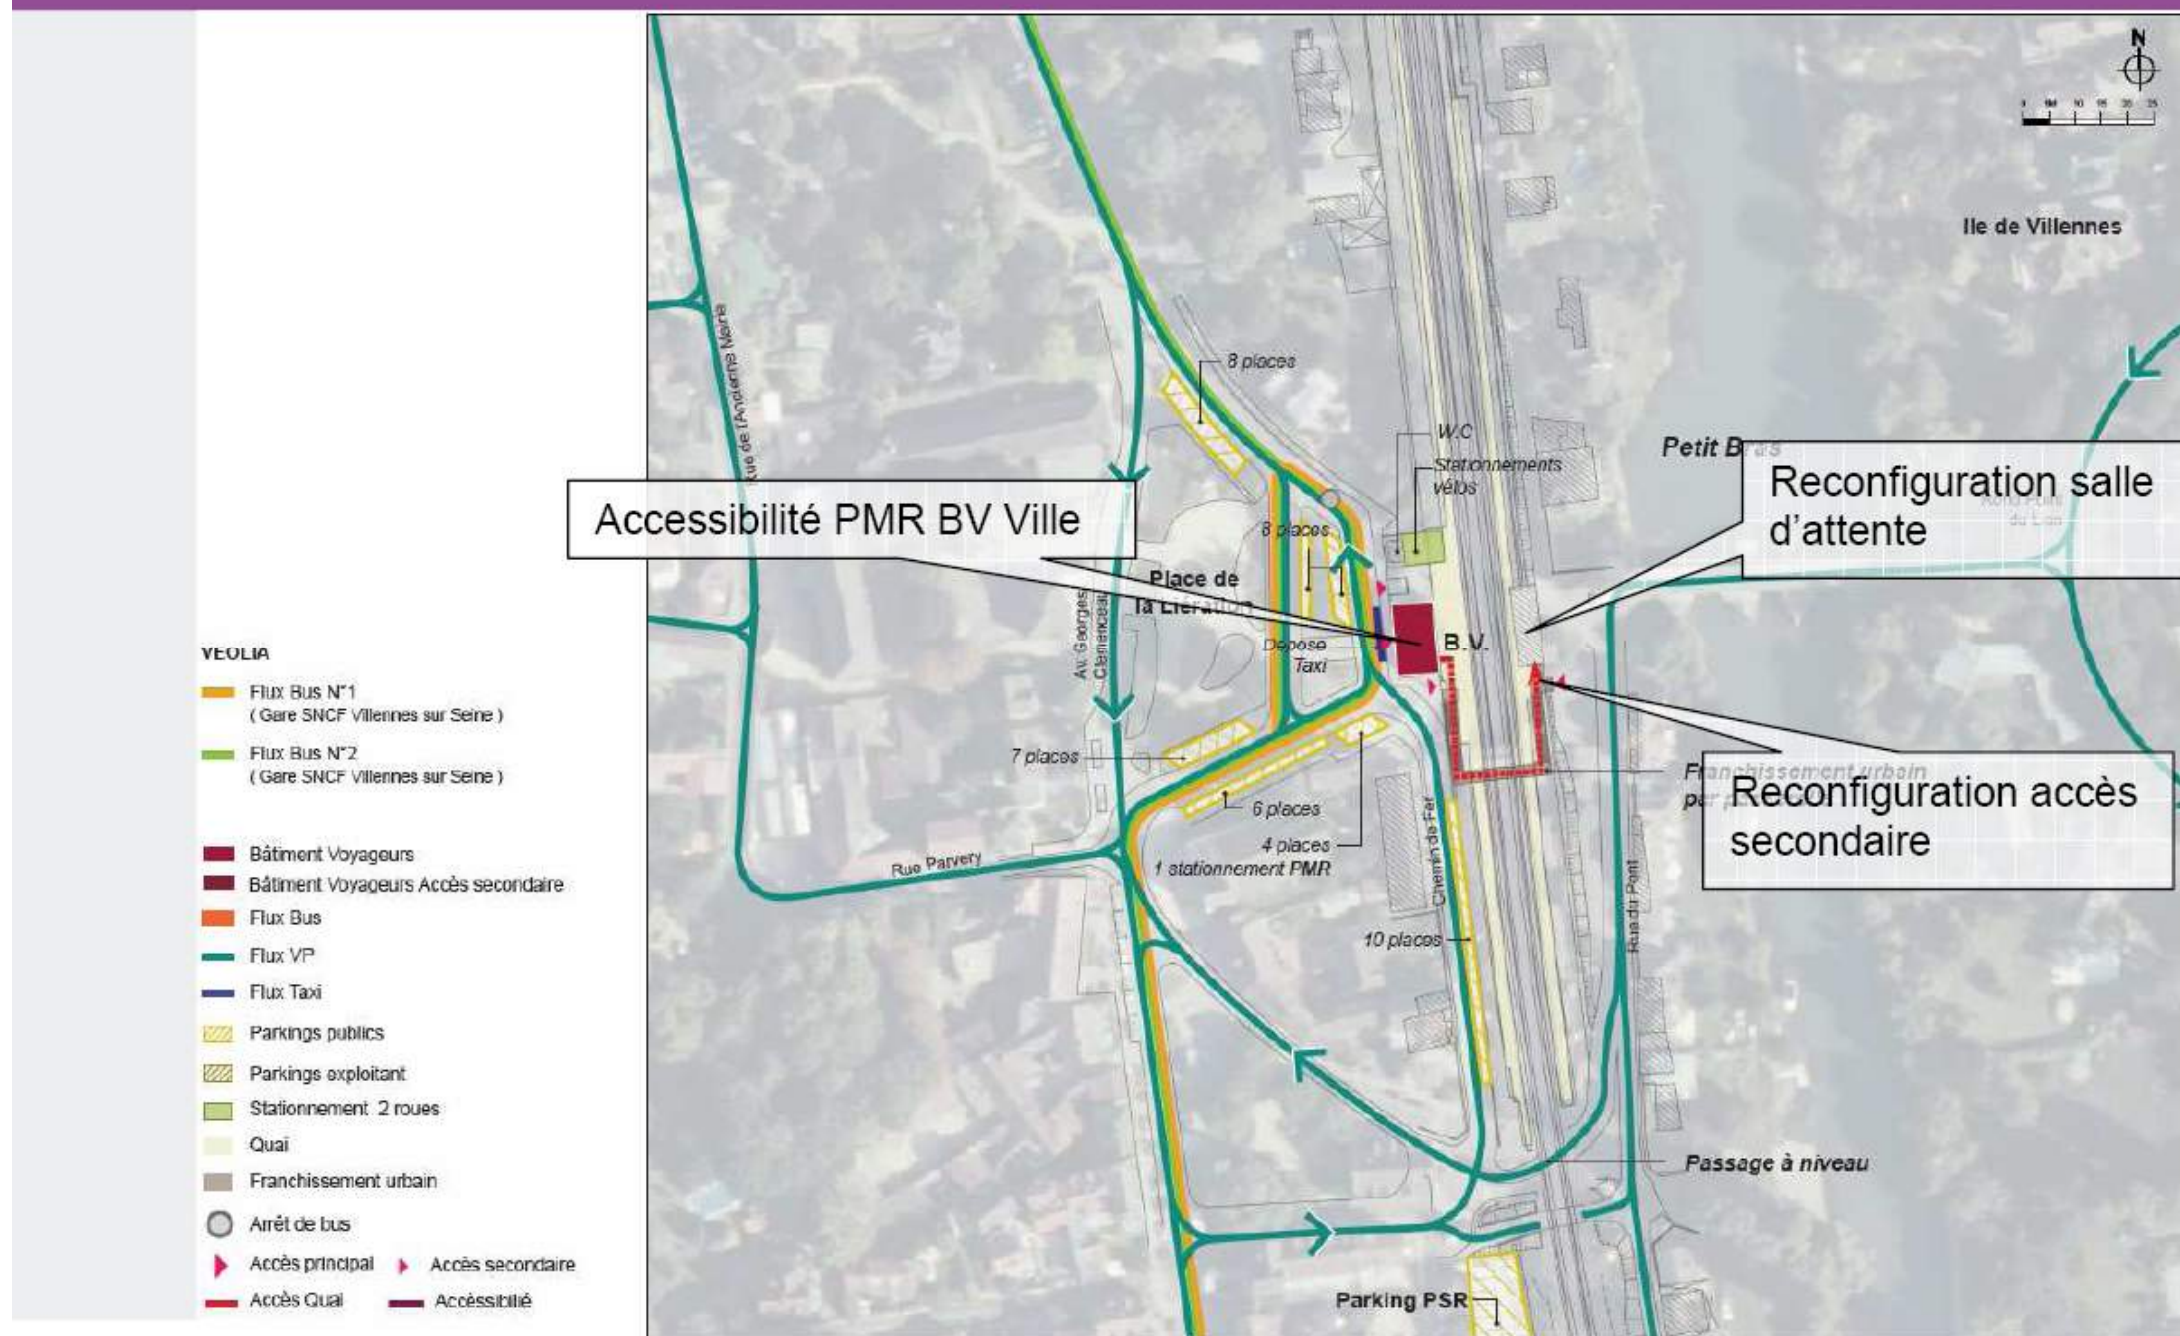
Plan d'aménagement de la gare de Villennes-sur-Seine
